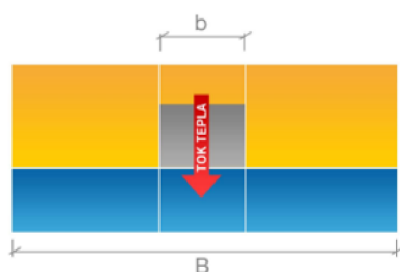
Tepelně-technické posouzení konstrukce stropu a střechy [27]
